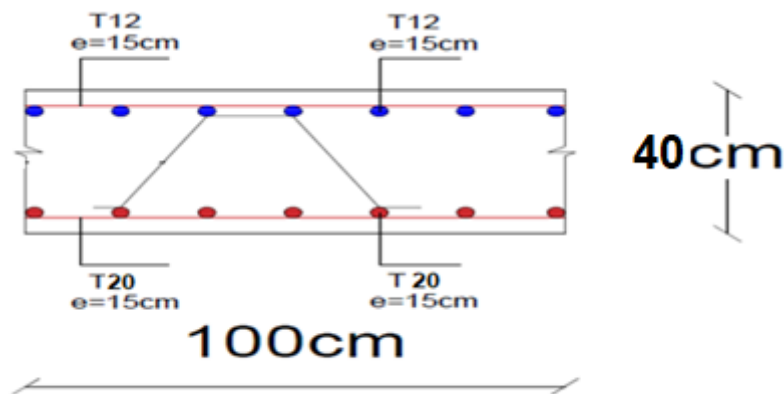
Schéma de ferrailage de la dalle de radier
